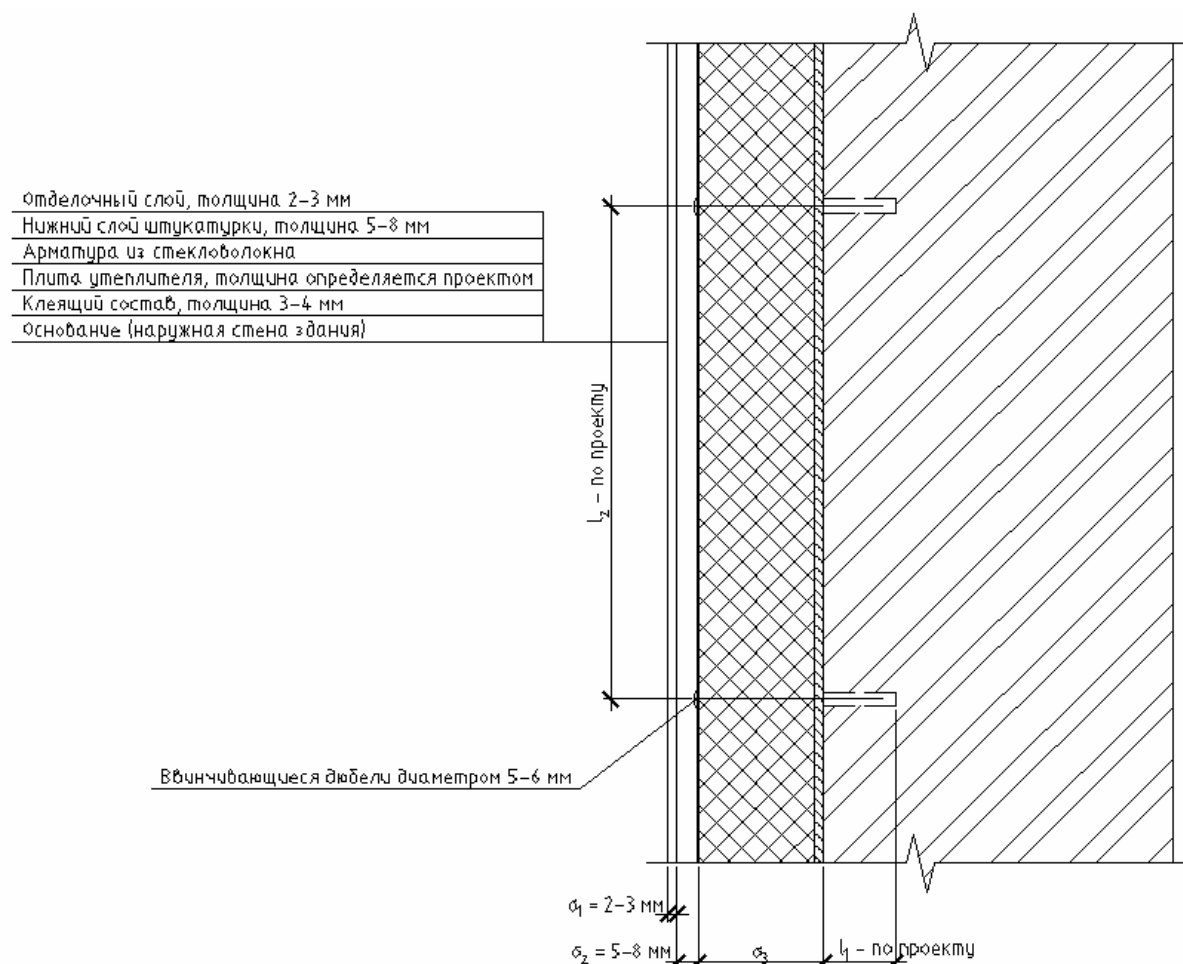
Фрагмент наружной теплоизоляции здания с тонкой штукатуркой по утеплителю
